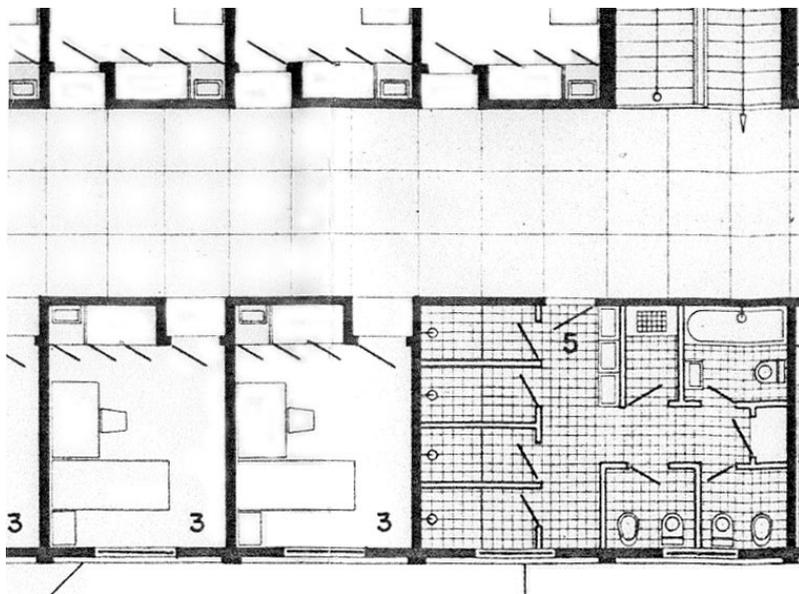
Trecho do Segundo Pavimento: Celas e Sanitário. Primeira versão de projeto. (Fonte: MNSG).
